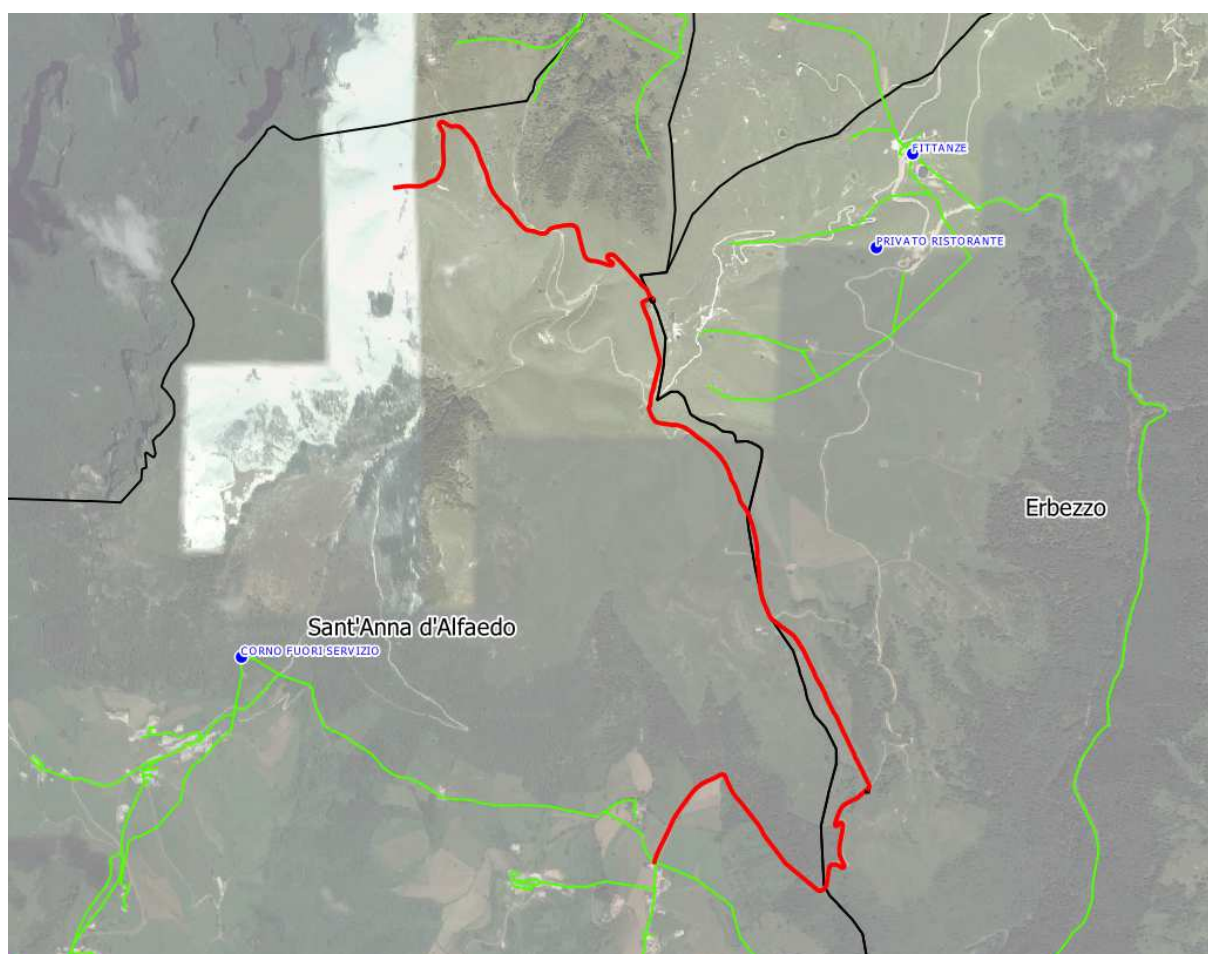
Planimetria generale del tracciato AB. In rosso il tracciato di progetto, in verde la rete esistente.
